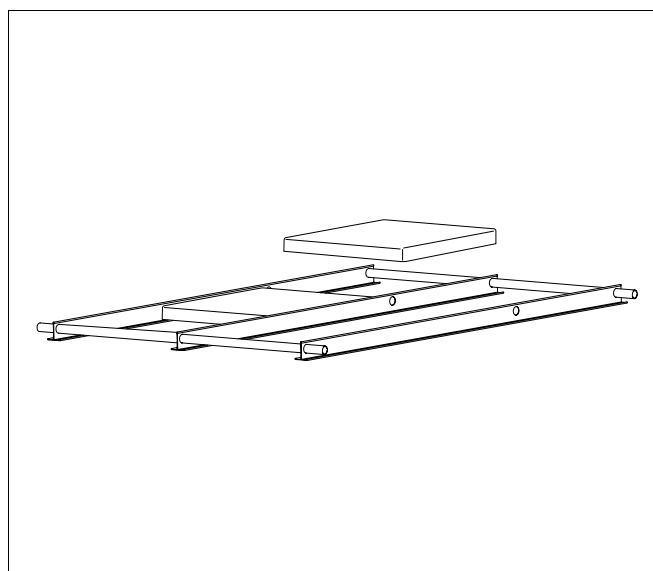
Grundrahmen mit Betonplatten stabilisieren
